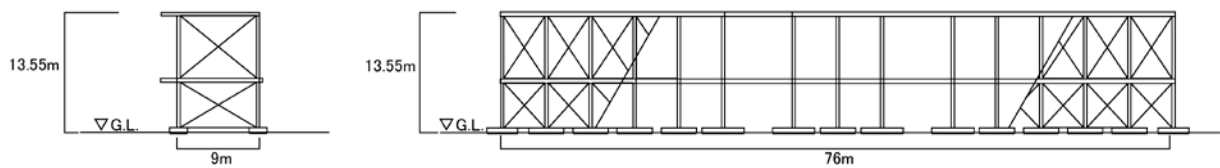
(4) 断面図 (E 設備架台、G 設備架台)
